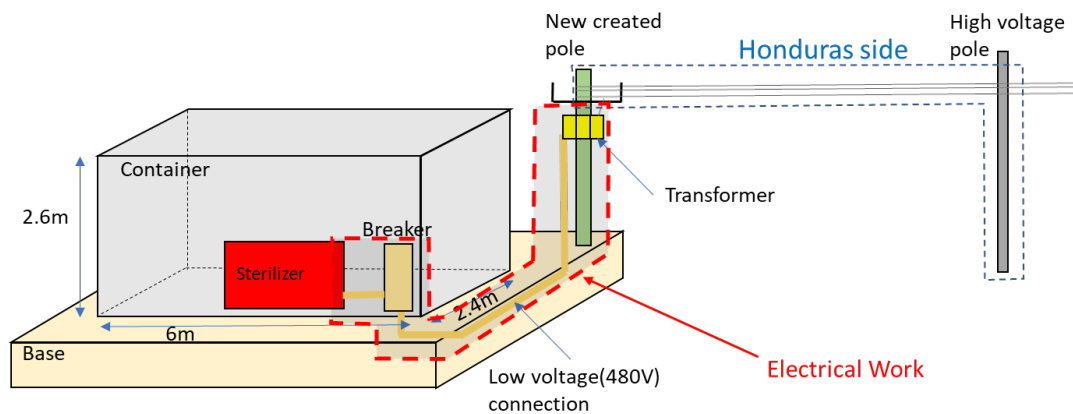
Imagen de la Instalación Eléctrica para el Contenedor y Transformador
